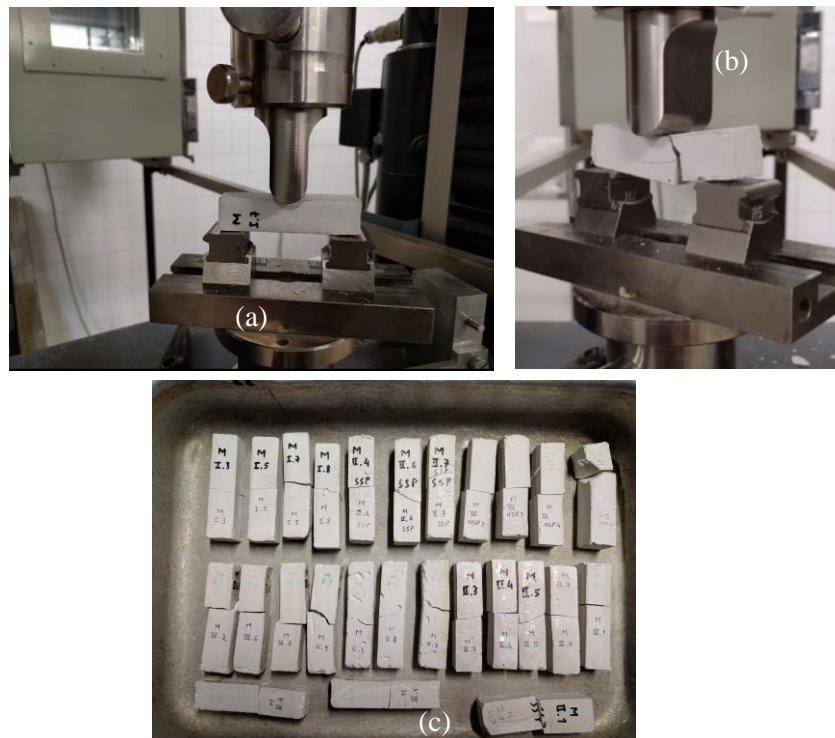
Ensaio de flexão – (a) Execução do ensaio; (b) Rutura do provete; (c) Provetes finais ensaiados
